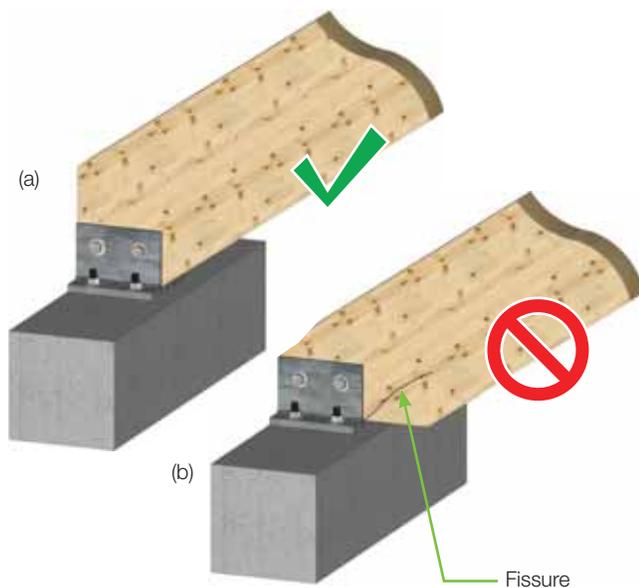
• Assemblage d'une poutre sur le côté d'une colonne
